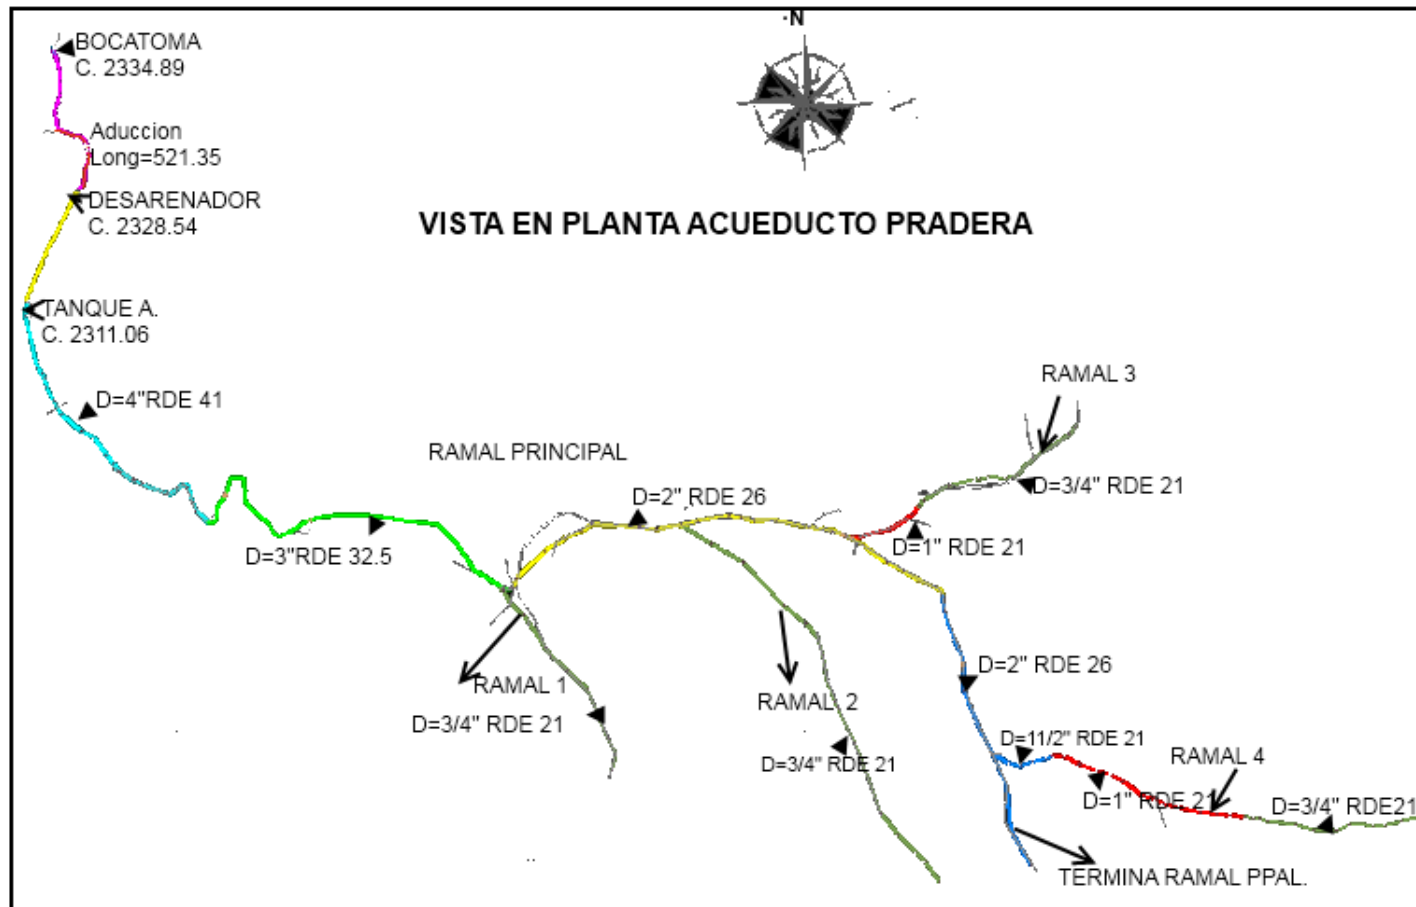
Vista en planta del acueducto pradera corregimiento de la Caldera
